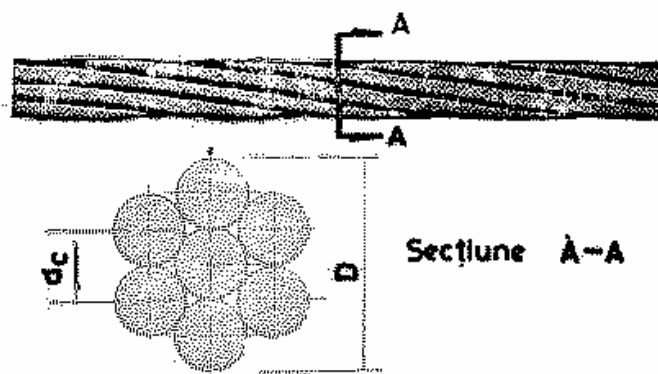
Toroane pentru beton precomprimat : vedere laterală și secțiune transversală
